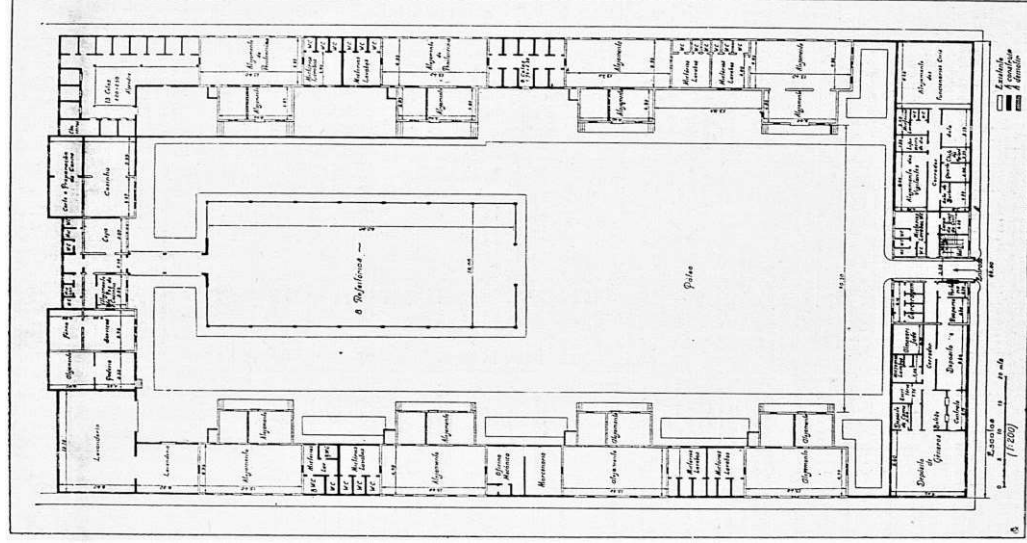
Planta do Presídio da Ilha Anchieta, 1942.
